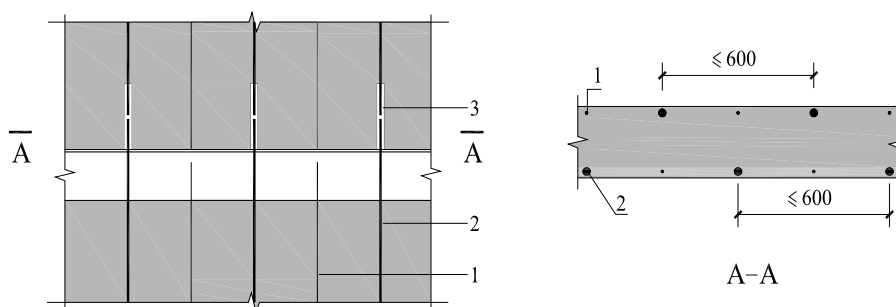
预制剪力墙竖向分布钢筋连接构造示意
